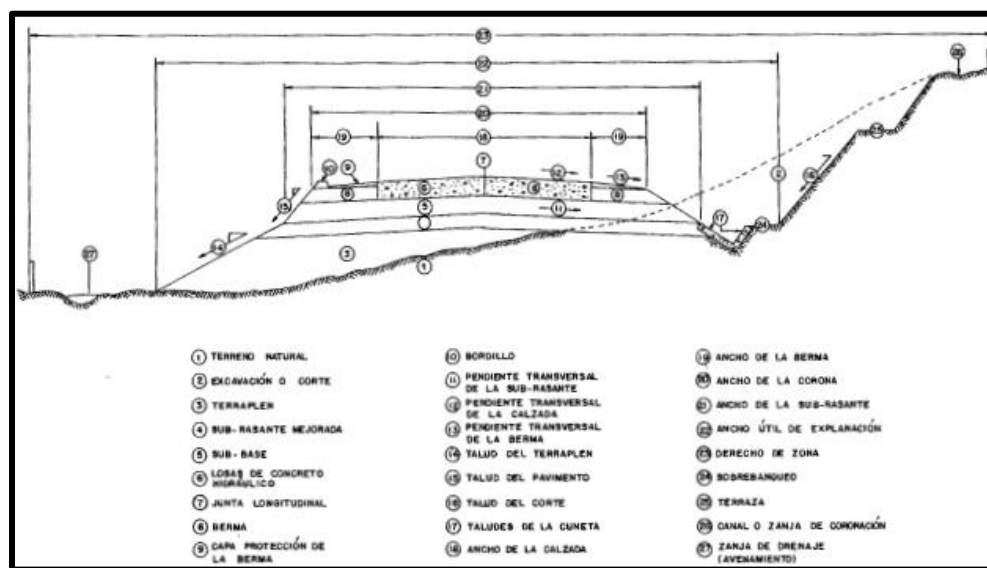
Sección típica de un pavimento. Fuente: Ingeniería de pavimentos para carretera
